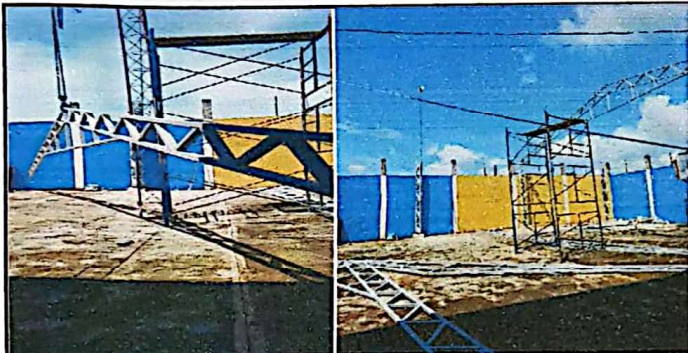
MANTENIMIENTO DE CANCHA CON VIGAS PRINCIPALES TIPO JOIST 225 M2 Y COSTANERAS 6"X2"
